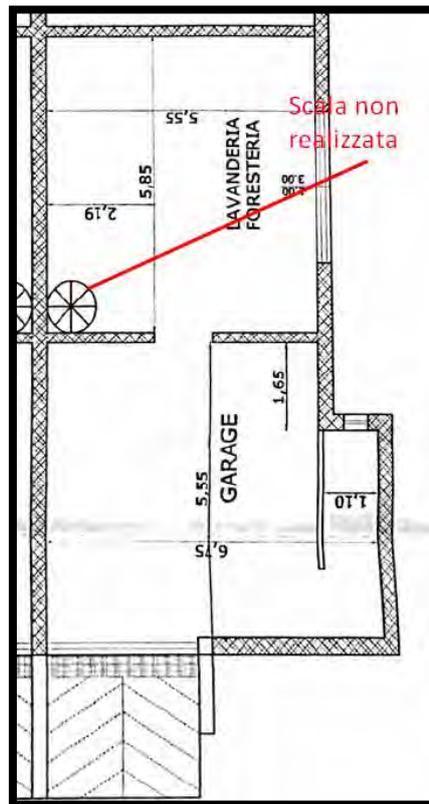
Pianta piano terra allegata alla CILA prat. n. 294/2011
